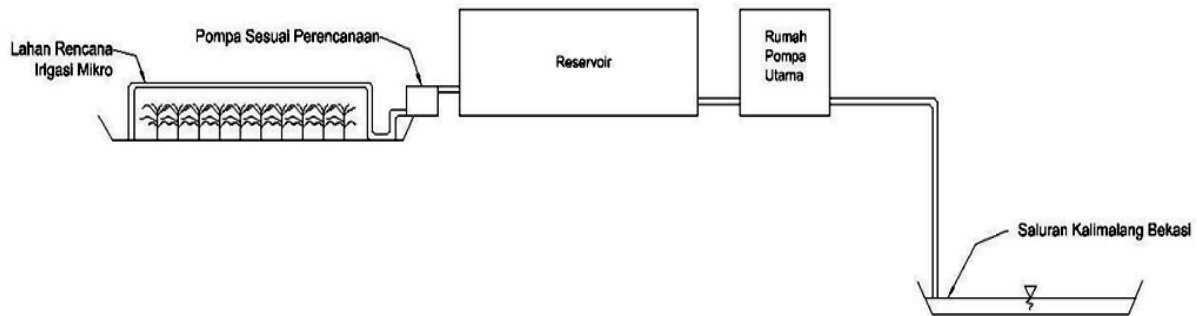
Layout detail jaringan irigasi mini sprinklers
